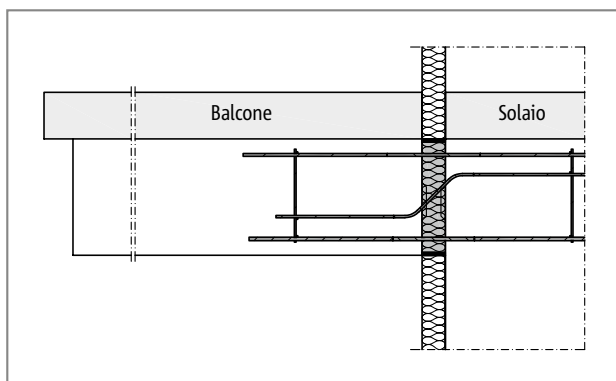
Schöck Isokorb® T tipo B: balcone con travi a sbalzo (balcone prefabbricato)
